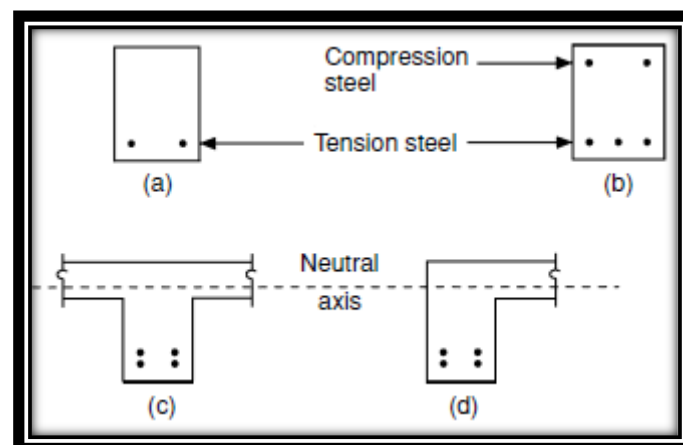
Sections de poutre : a) simplement armées ; b) doublement armées ; c) Section T ; d) Section L.
